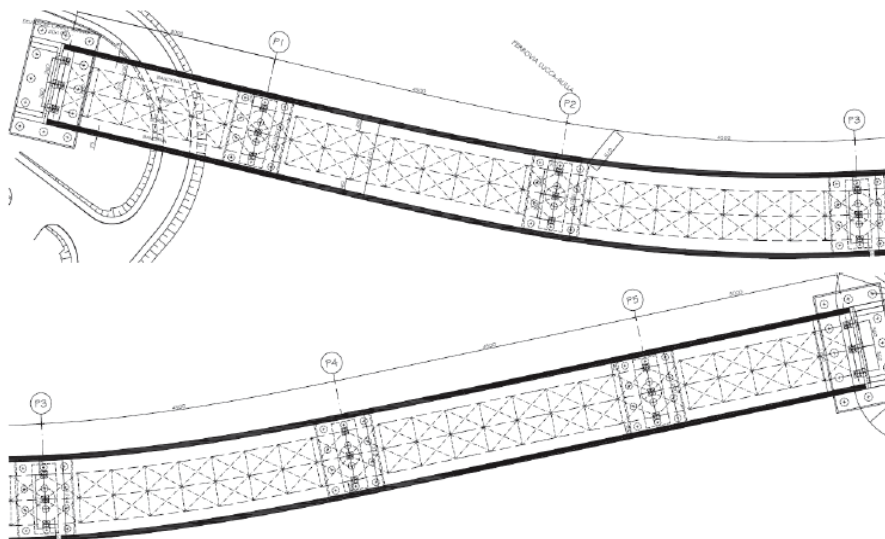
Cavalferrovia Lucca-Aulla: pianta impalcato
